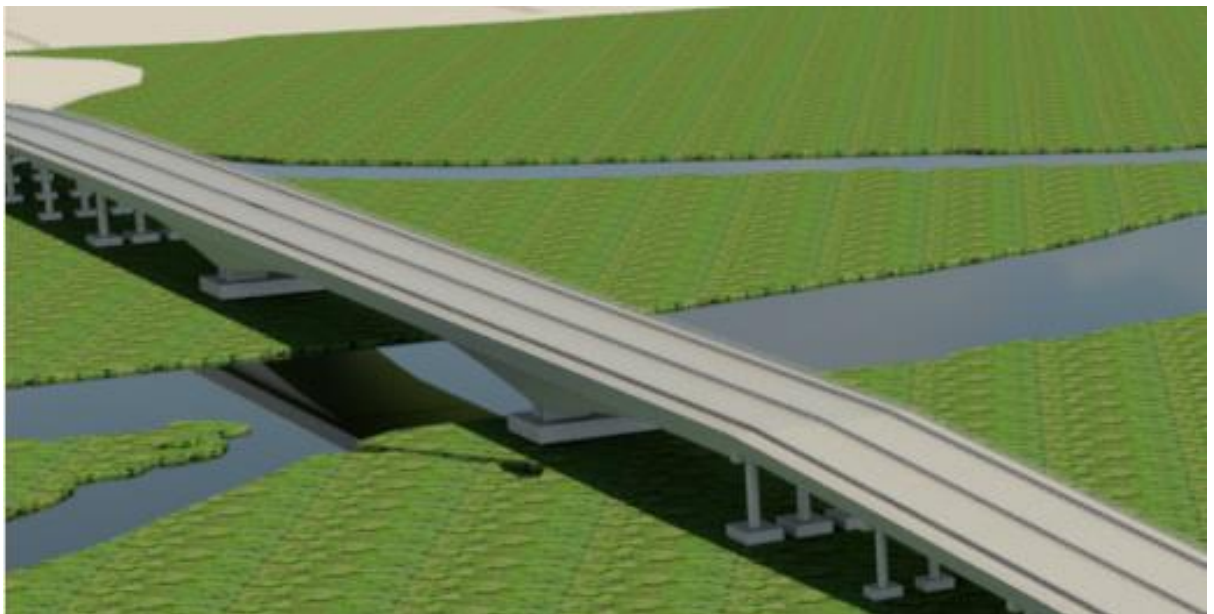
Modelo em perspectiva da implantação da Ponte. Fonte: Planave (2016)
